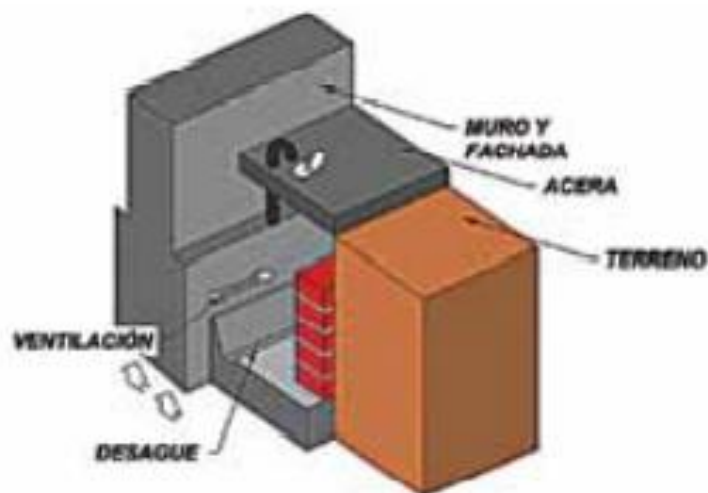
Cámara ventilada. Fuente (Peñaranda, 2011)
